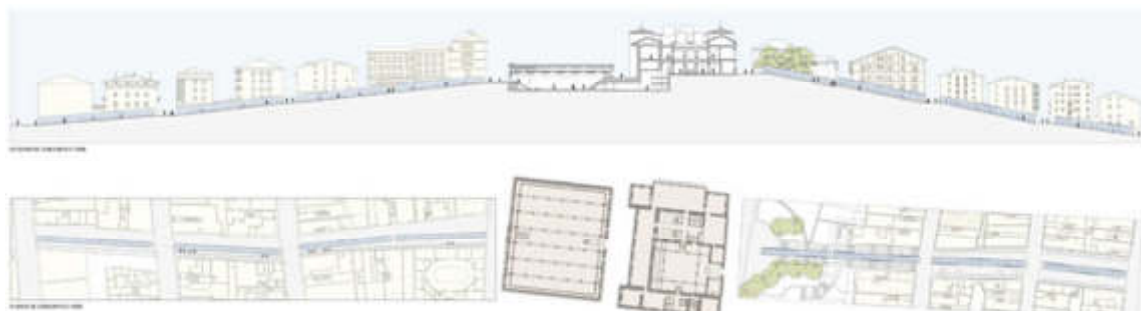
Corte longitudinal e Planta das rampas de Vitoria-Gasteiz (Roberto Ercilla, 2010)
